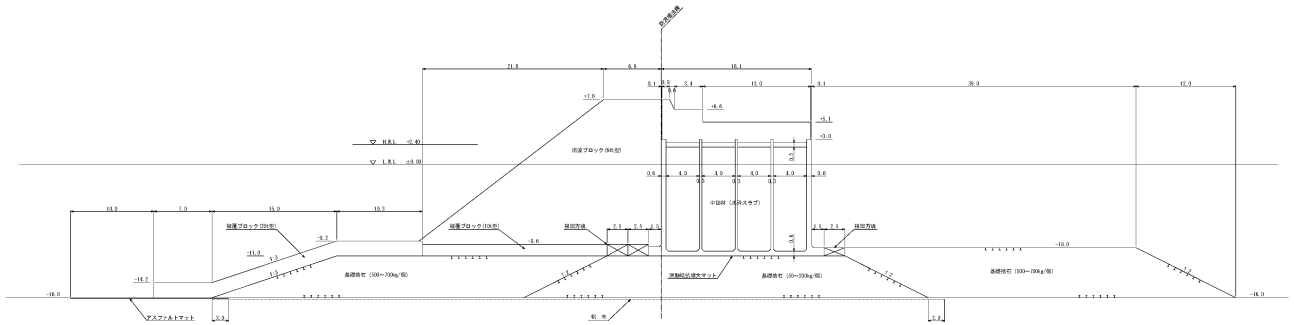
標準断面図（防波堤Ⅲ，単位：m）
